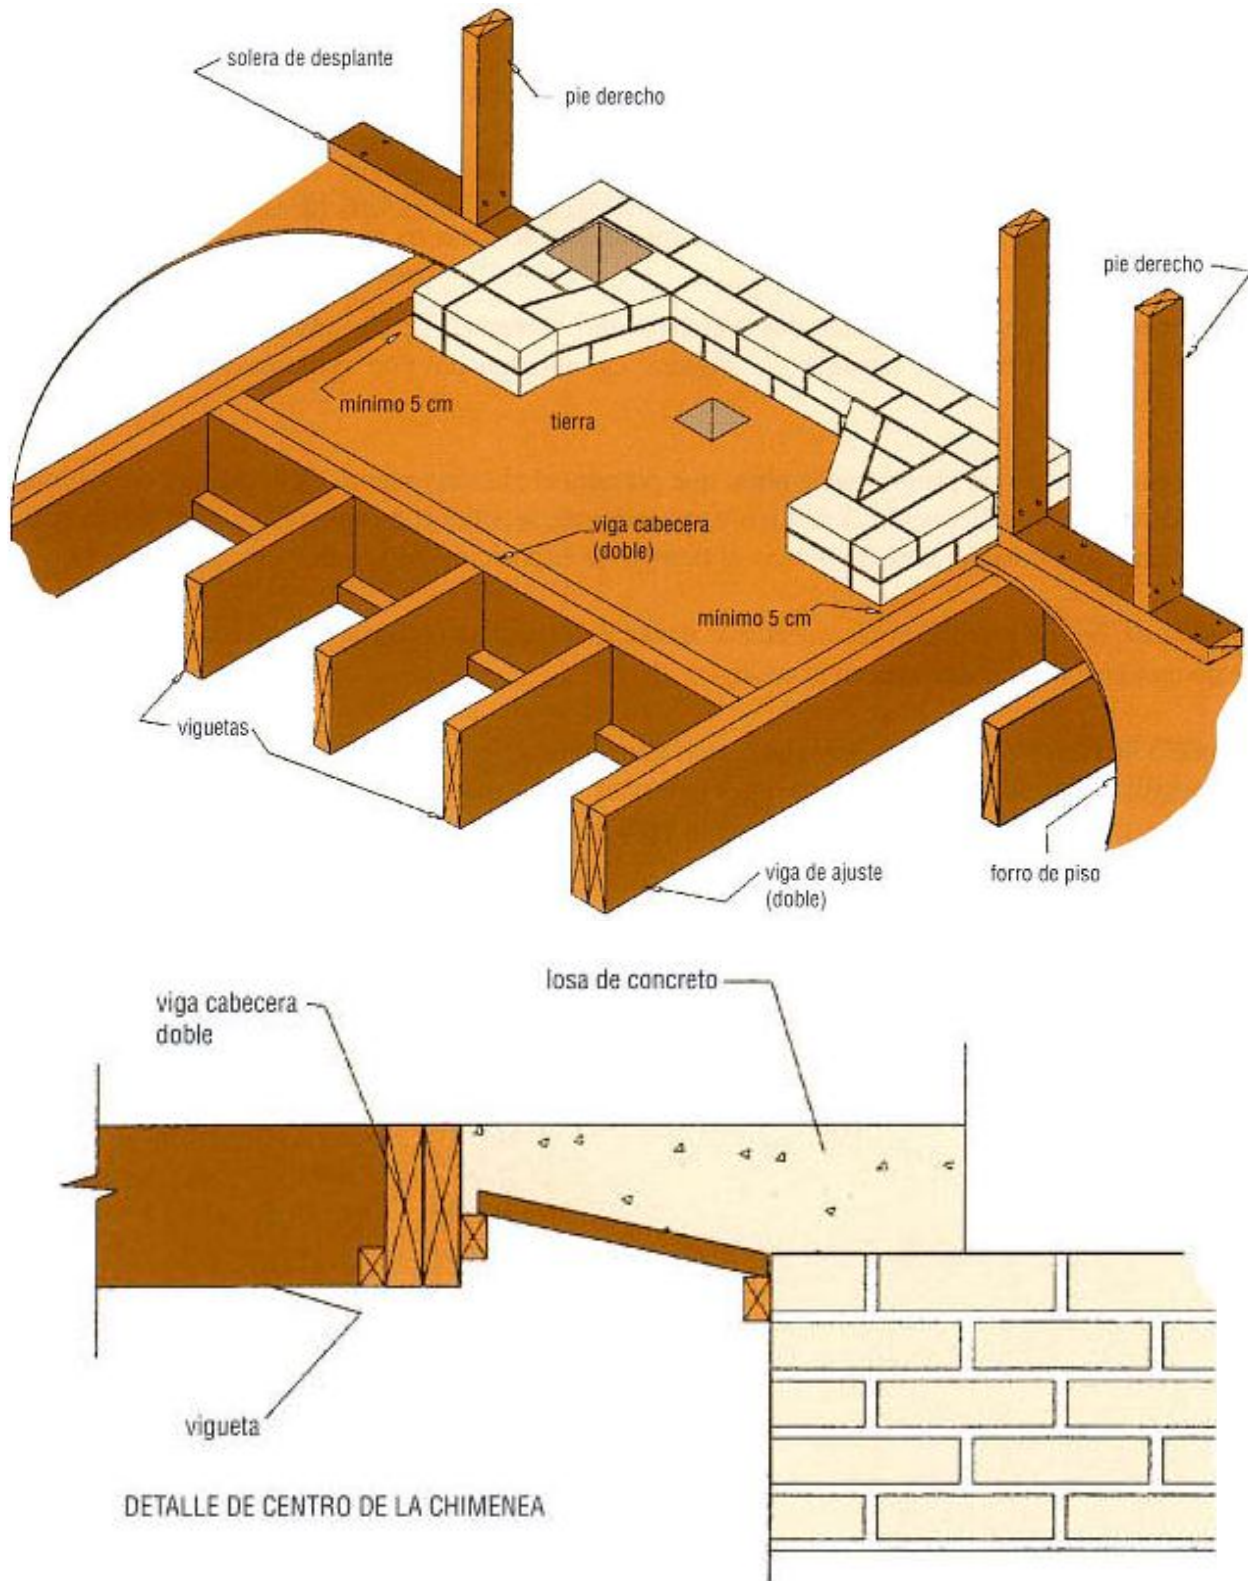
Estructuración de Muros y Piso en zona de chimenea.
